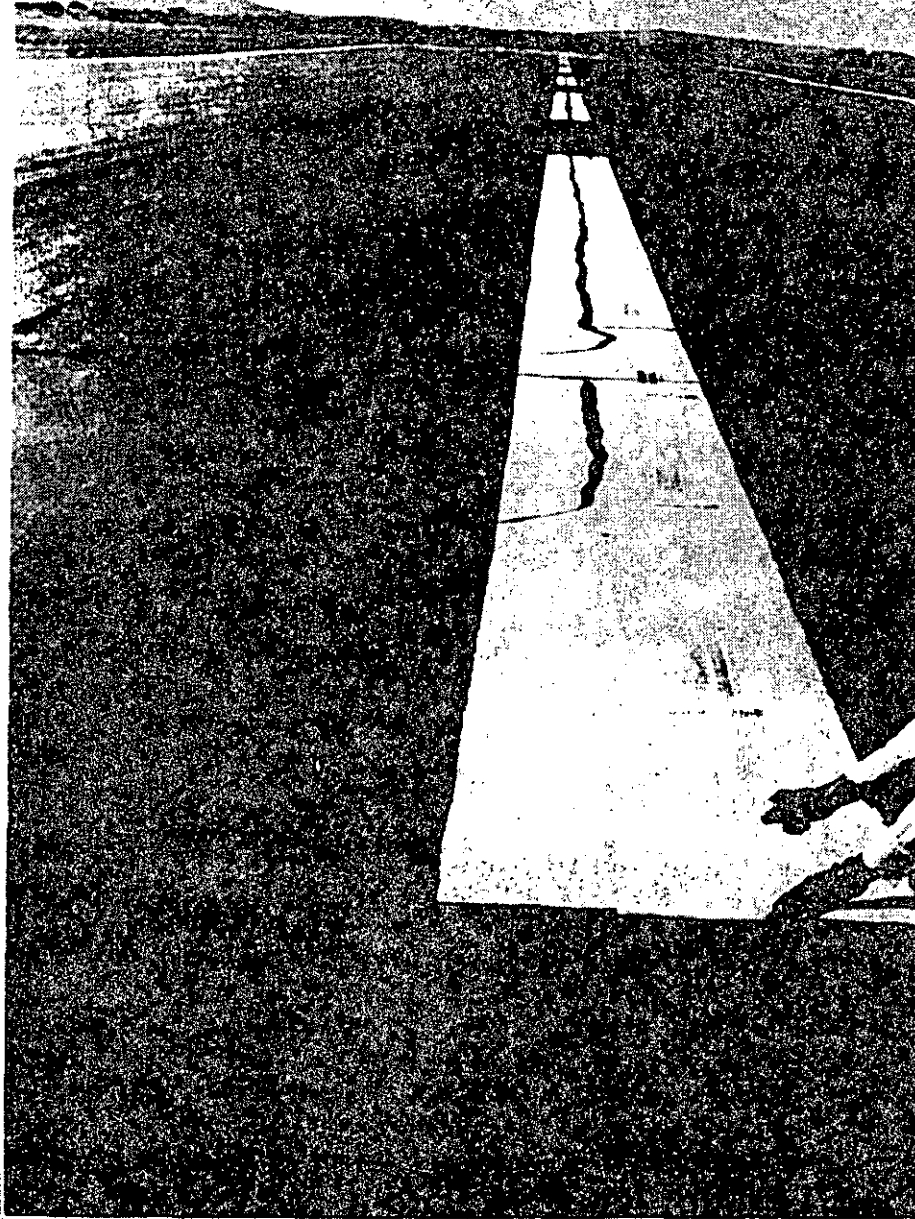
Grietas longitudinales en el eje de la pista
